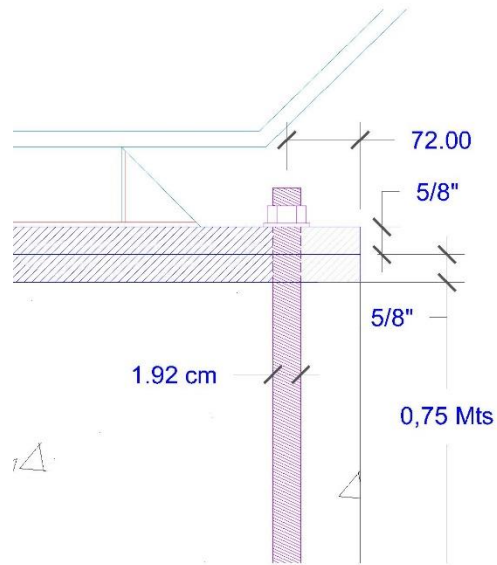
Detalle del corte, pernos de anclaje, placas y canaleja.
